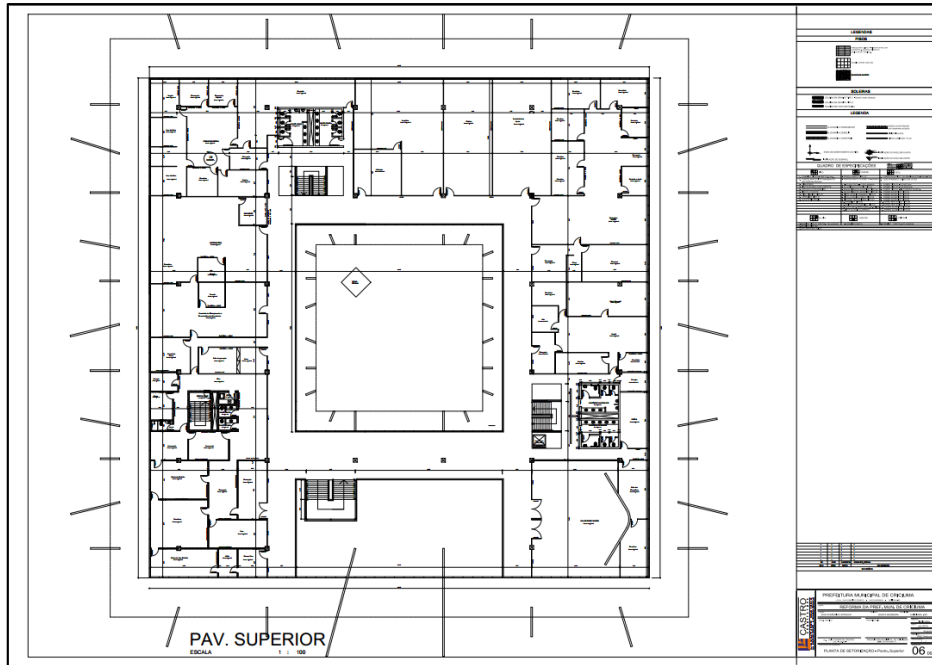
Planta baixa pavimento superior. (Fonte: PMC)
